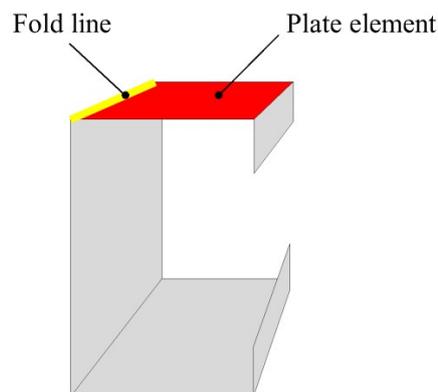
Definizione per profilo a “C” di fold line e plate
